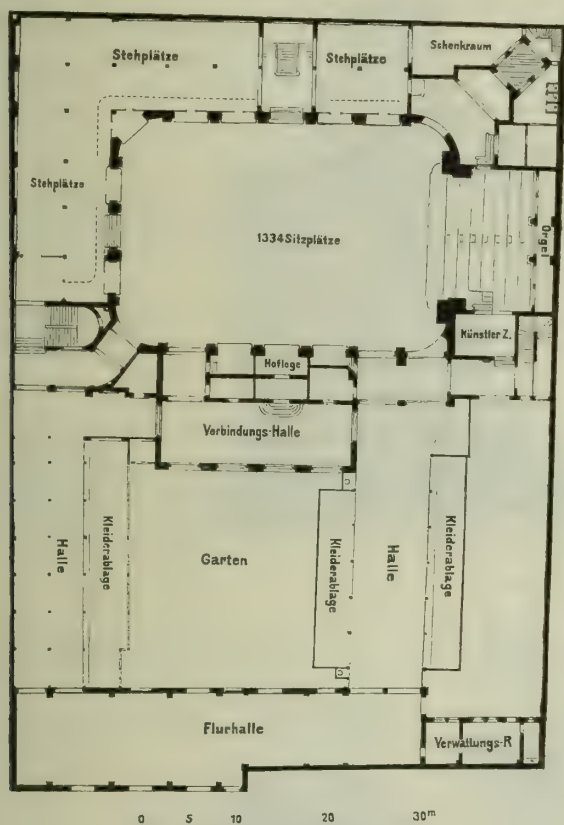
Grundriss vom Erdgeschoß.
